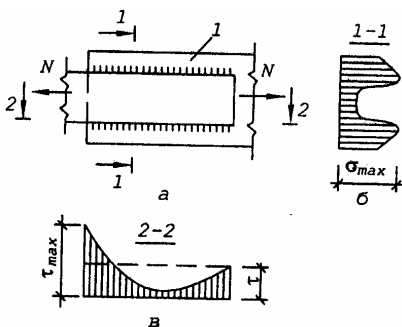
З'єднання на флангових швах: а – план з'єднання; б – епюра нормальних напружень у перерізі 1-1 елемента 1; в – епюра дотичних напружень у шві, переріз 2-2
